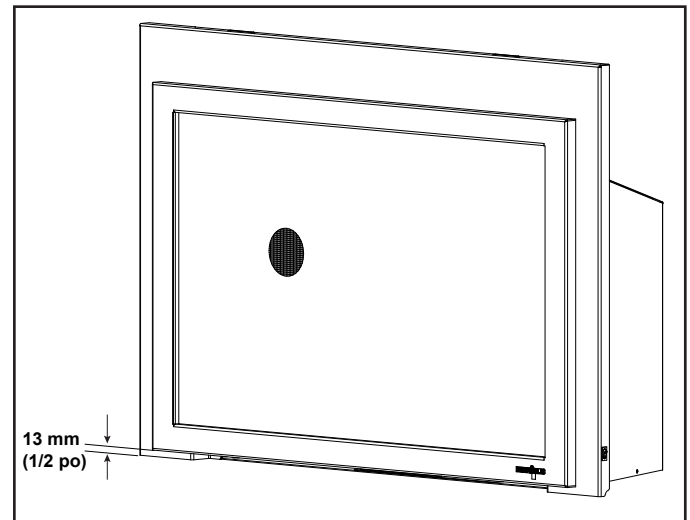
Minimum requis de 12,7 mm (1/2 po) Espace en bas de la façade
